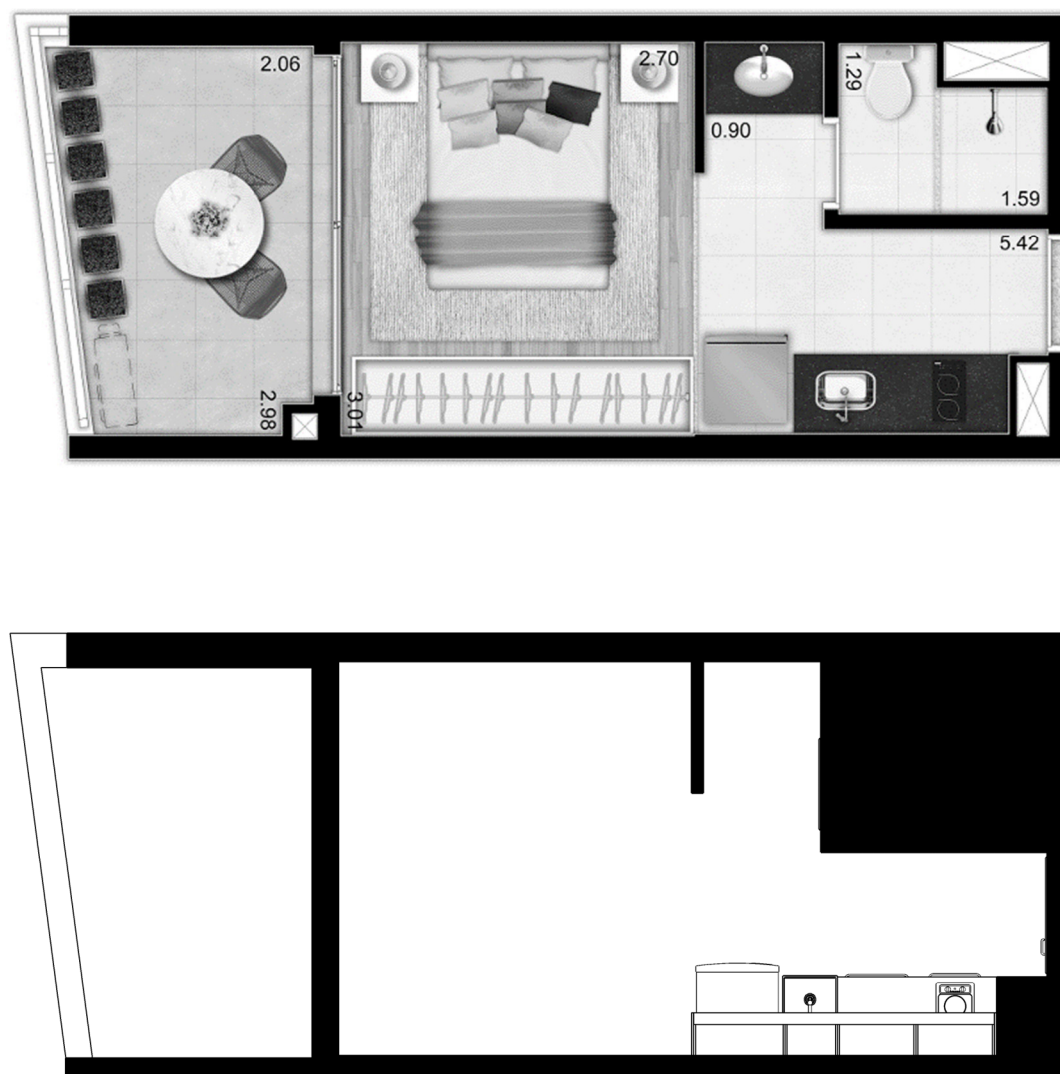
Acima: planta baixa do empreendimento Benedito. Abaixo: planta baixa da simulação da instalação do sistema modular proposto. Fonte da imagem: acima disponível em www.even.com.br (acedido fev. 2018) abaixo elaborada pelo autor.
